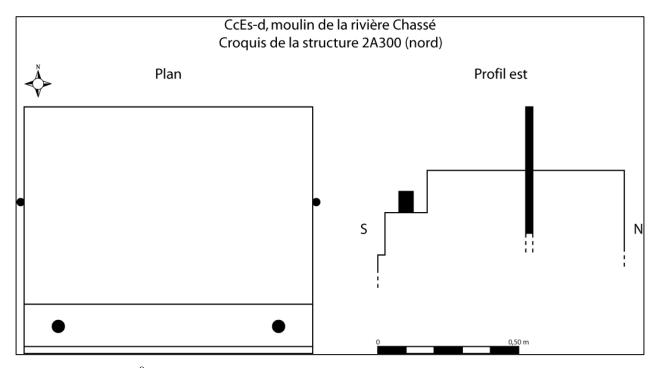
Projet nº 154-09-0389, site CcEs-d, plan et profil de la section nord de 2A300
